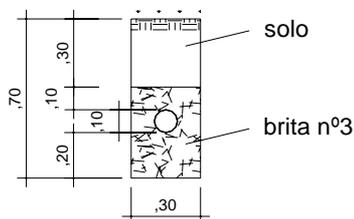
Perfil do início da vala de infiltração. *Dimensões em metros (m).
